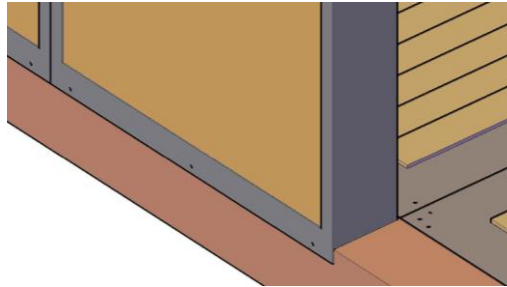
Detalhe do assentamento da parede exterior na viga da base.
